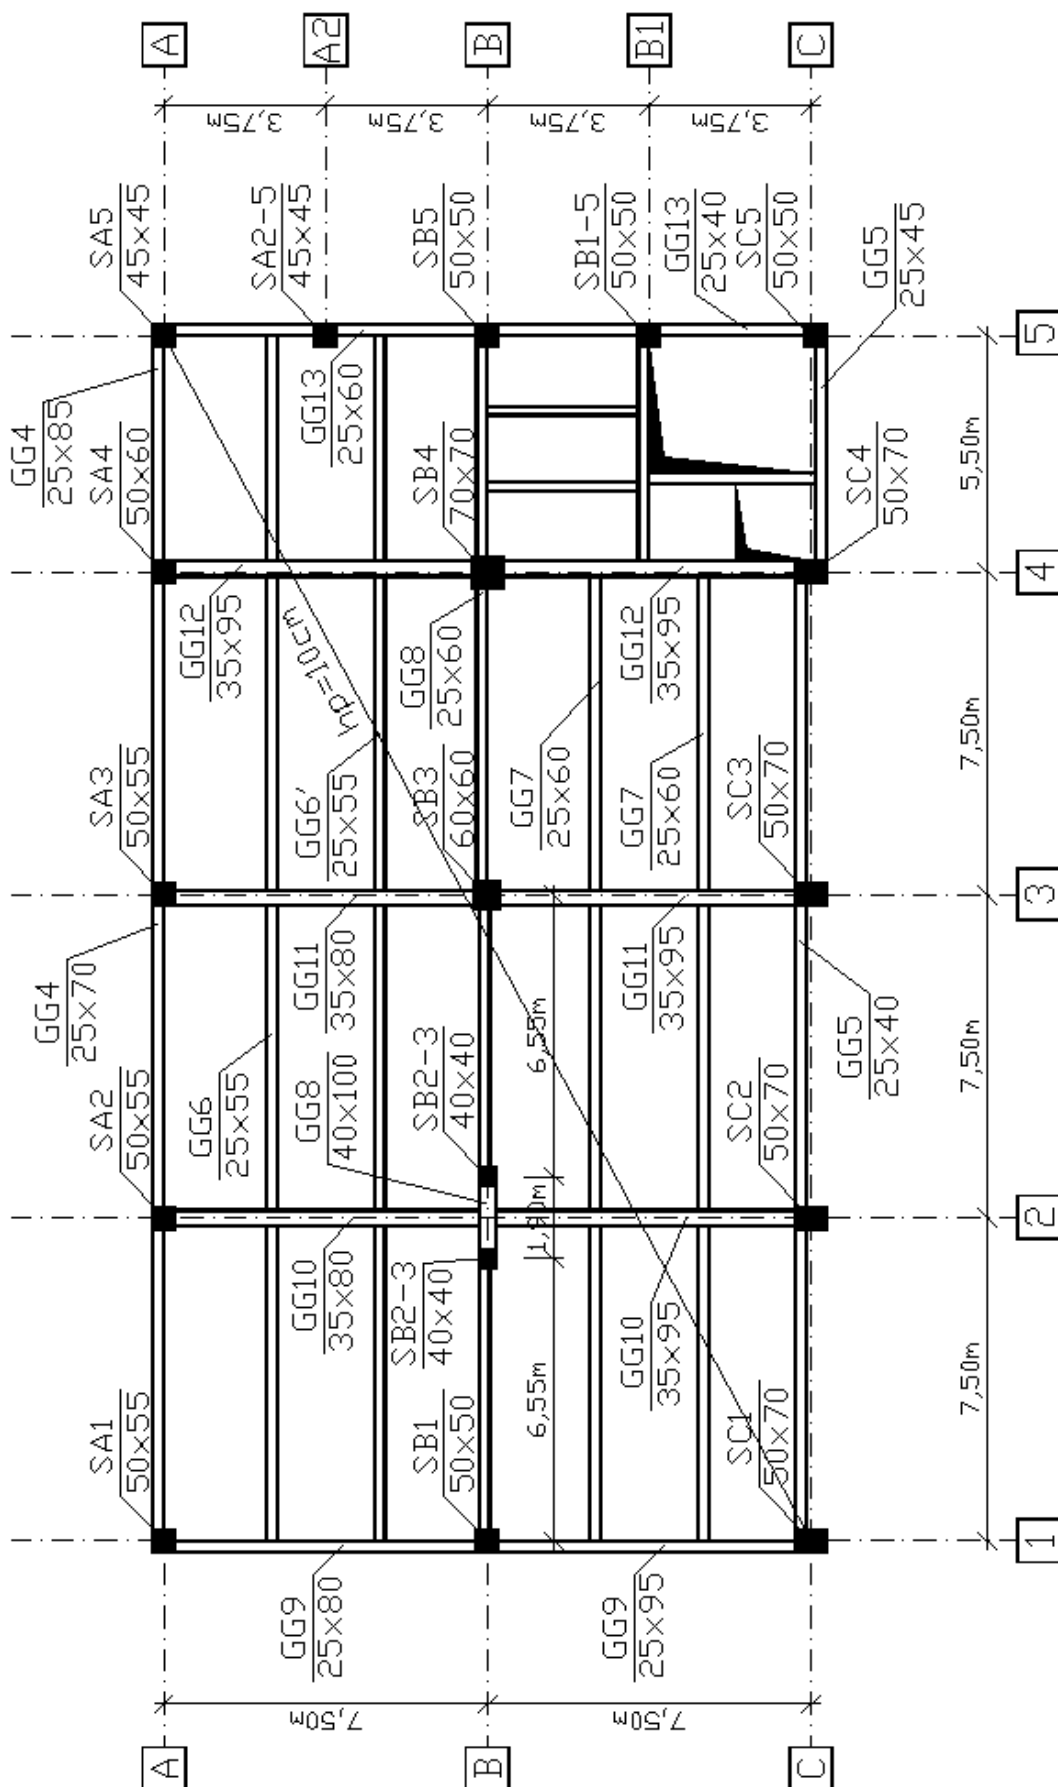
Planșeu cota +10,80 m – plan cofraj.
